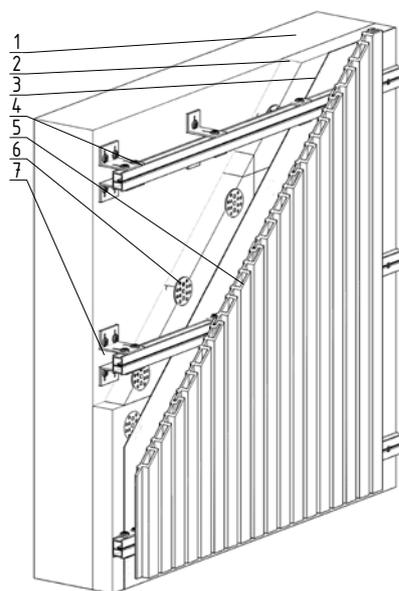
Монтаж несущего профиля с помощью фасадного кронштейна
